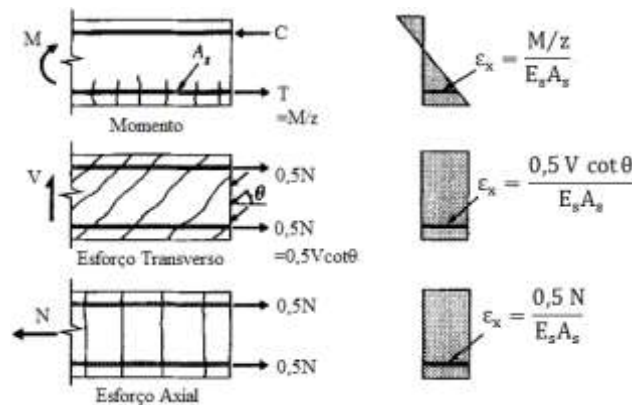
Exemplo da determinação de ϵ_x em vigas não pré-esforçadas [1].
